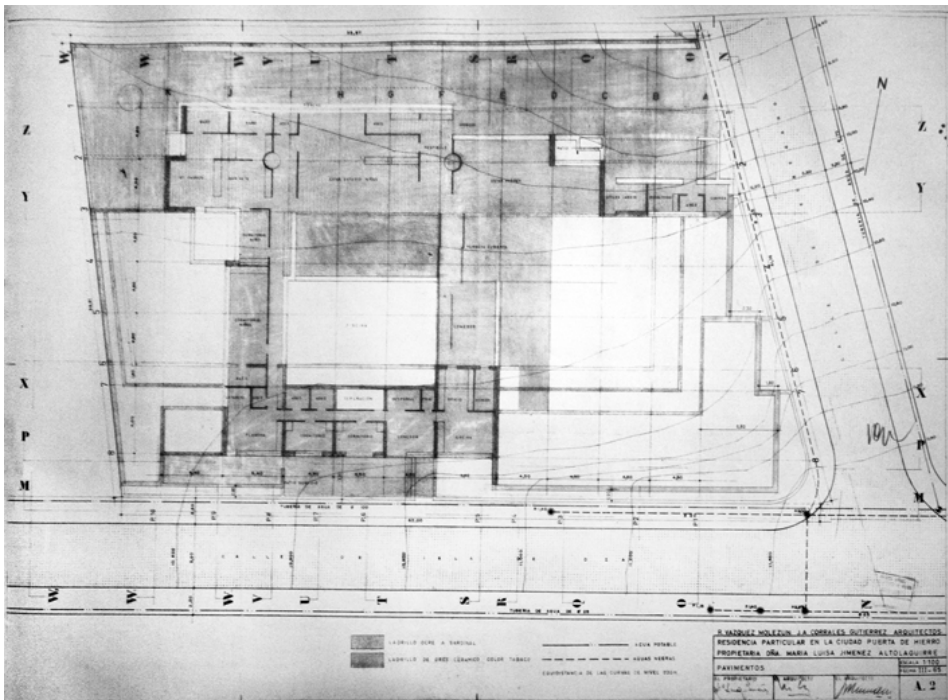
Casa Huarte. Plano A-2 de Pavimentos. Proyecto de Ejecución. Marzo 1965. Aparecen sombreados dos tipos de pavimentos: ladrillo de gres cerámico color tabaco refractario en el interior y ladrillo ocre colocado a sardinel en las zonas exteriores. Plano: Legado Vázquez Molezún, Fundación COAM
